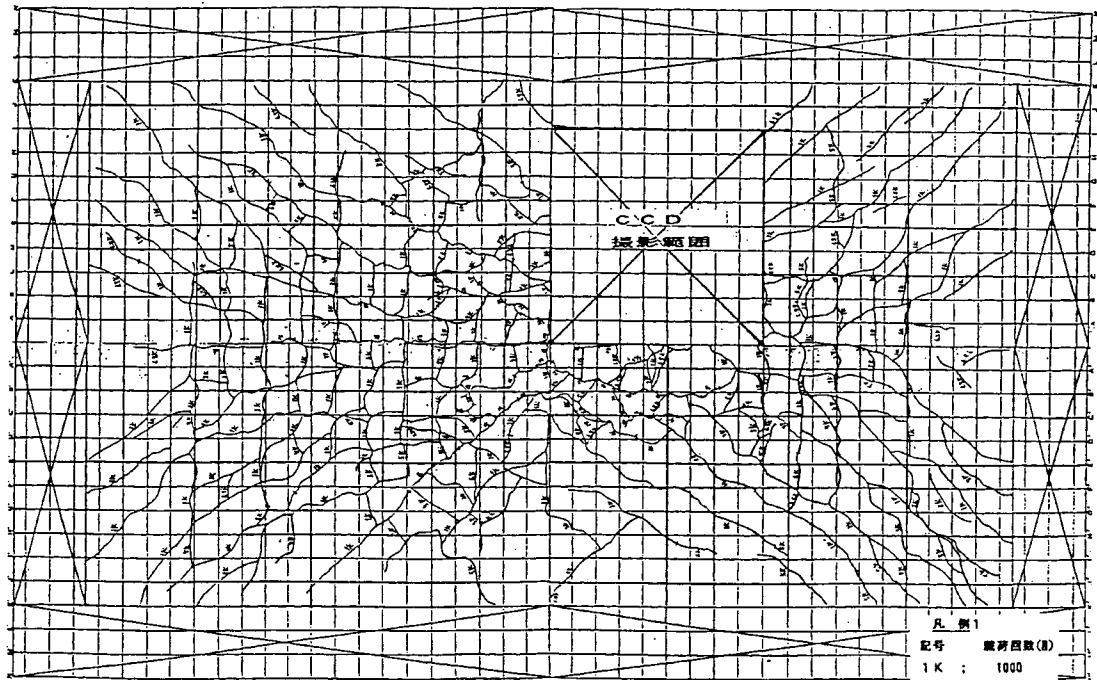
損傷度Ⅱの床版下面におけるひび割れ状況の一例(RC39+鋼板-1 供試体)
